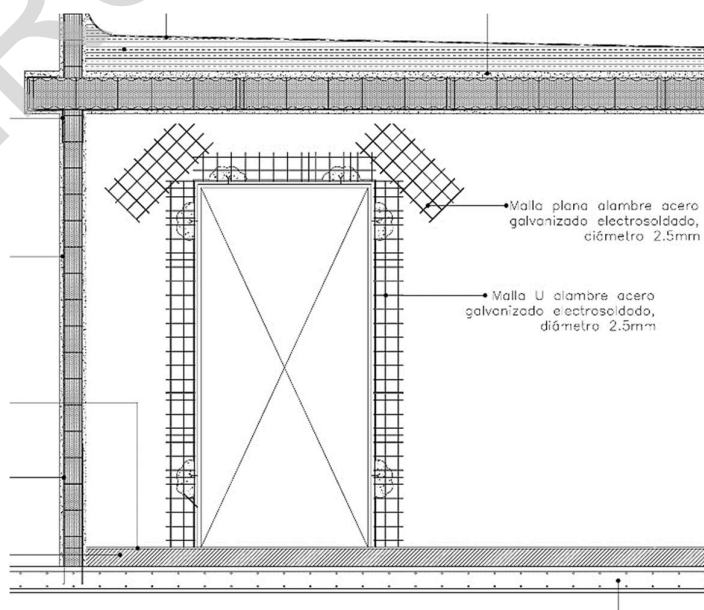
Refuerzo con malla plana a 45° en esquinas y malla U en todo el perímetro de las aberturas
